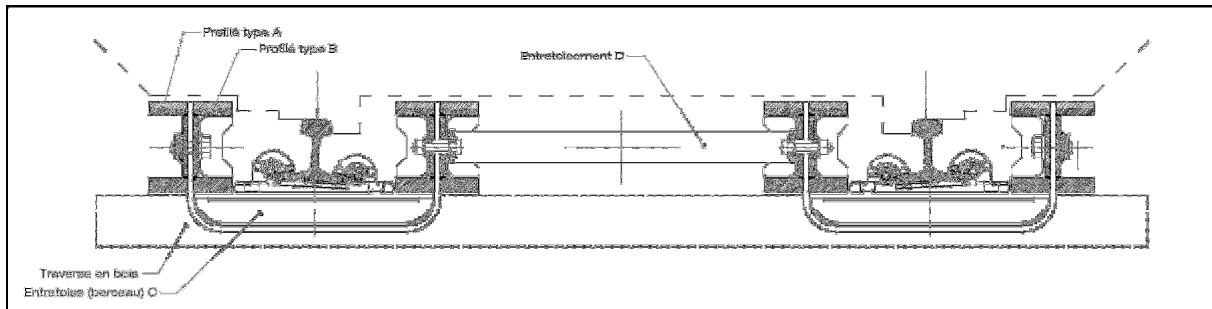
Coupe transversale d'un renforcement de voie de 7 m
